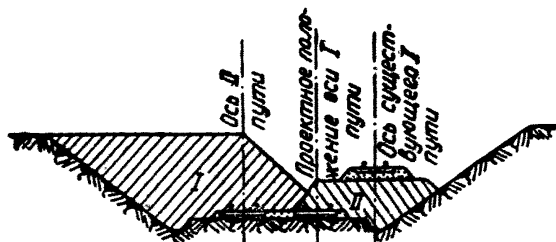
Схема разработки выемки второго пути ниже уровня существующего пути со смещением его оси
